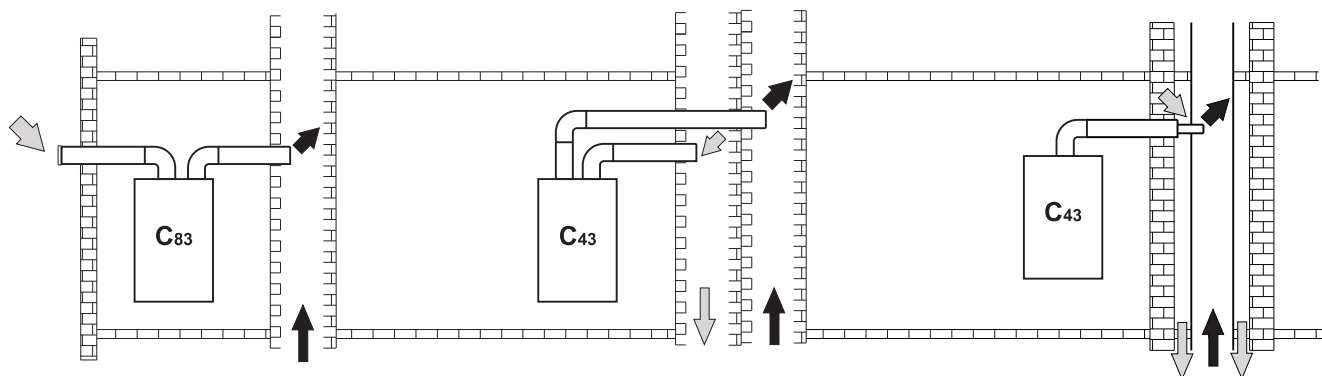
Exemples de raccordement à des conduits de cheminée (⇐ = Air / ➡ = Fumée)
